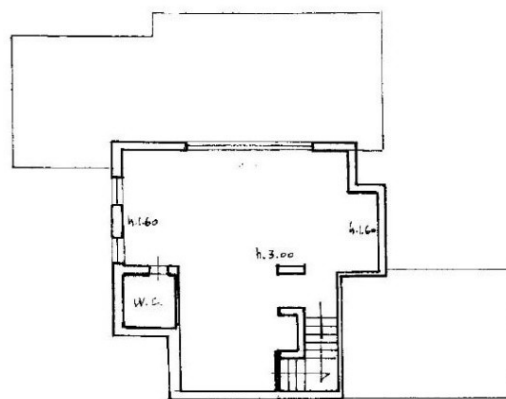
Stralcio plan. Catastale subalterno 4
